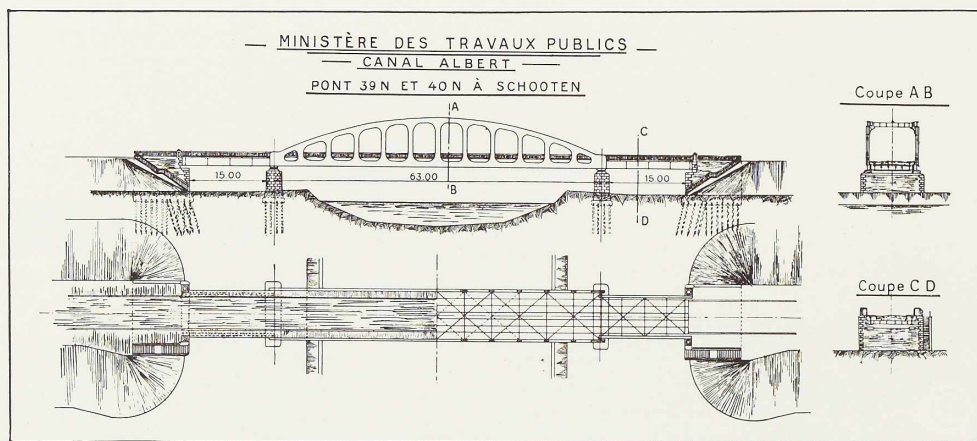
Élévation générale, plan d'ensemble et coupe transversale des ponts 39 N et 40 N de Schooten.
